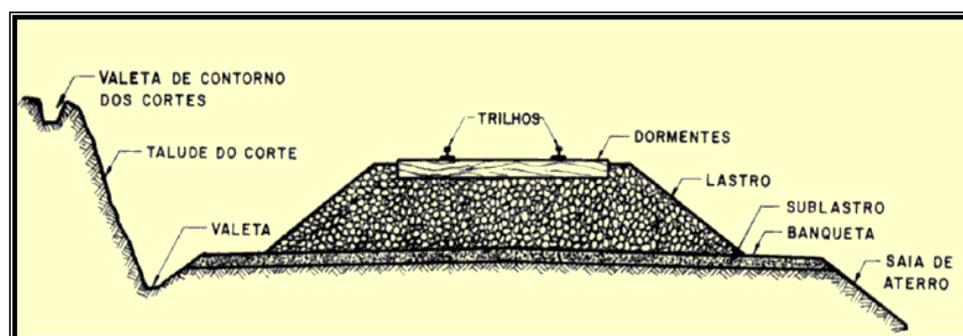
Detalhe da Infraestrutura e da Superestrutura. Fonte: Brina, Helvécio Lapertosa - Estradas de Ferro.
